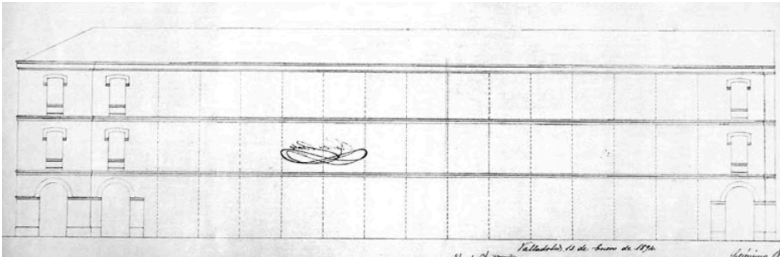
Fachada sur dibujada por Ortiz de Urbina en los planos del proyecto inicial. 1894. Fuente: AMVA
